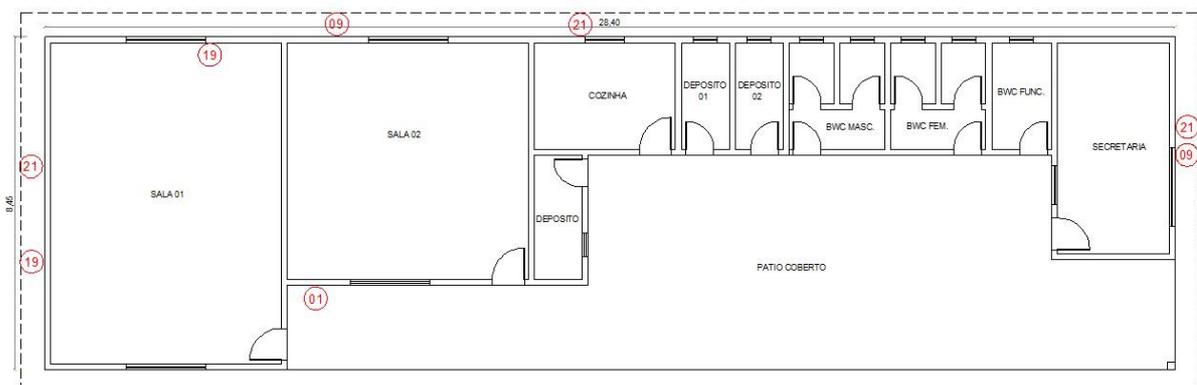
Planta Baixa creche Pequeno Mundo – Cristo Rei
